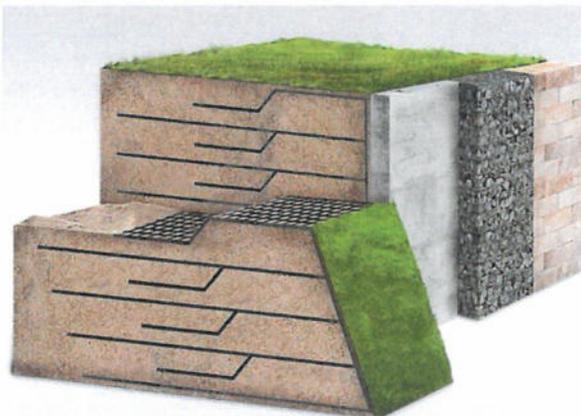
Querschnitt Straßendamm in „Bewehrter Erde“ Ausführung
